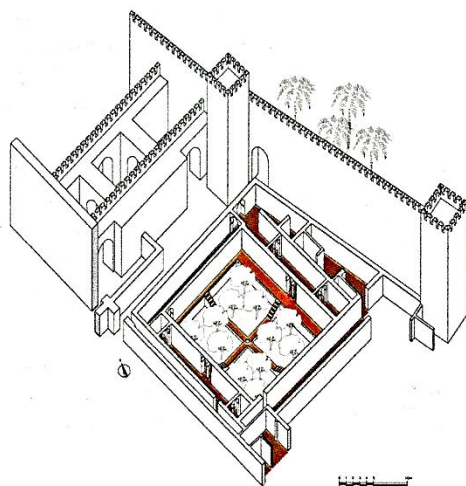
Tipo 4. Patio de crucero bajo la Montería.
